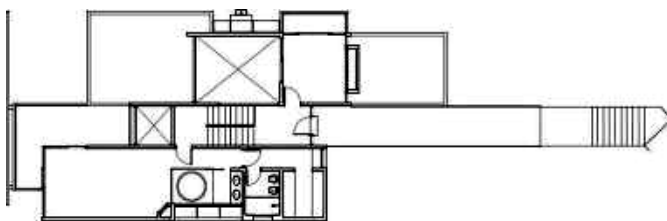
Planta baixa esquemática do nível 1 e 2 com passarela de acesso. BONETTI (2000)
